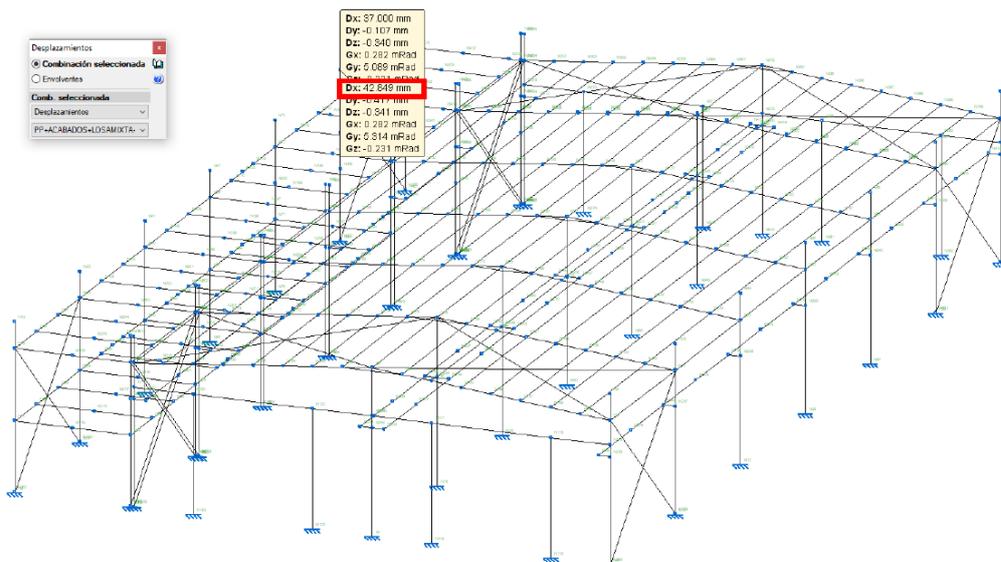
Máximo desplazamiento horizontal (Oficinas)
